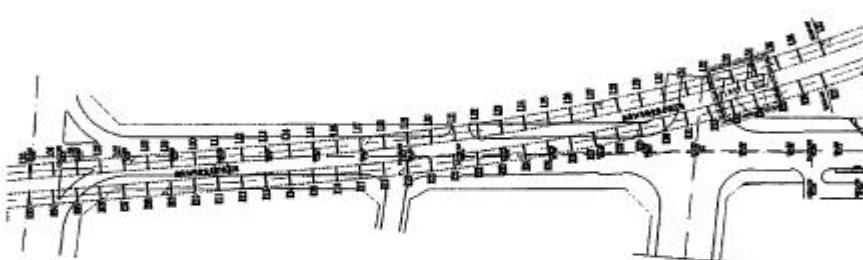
沙湖路市政工程与地铁线路位置关系平面图
